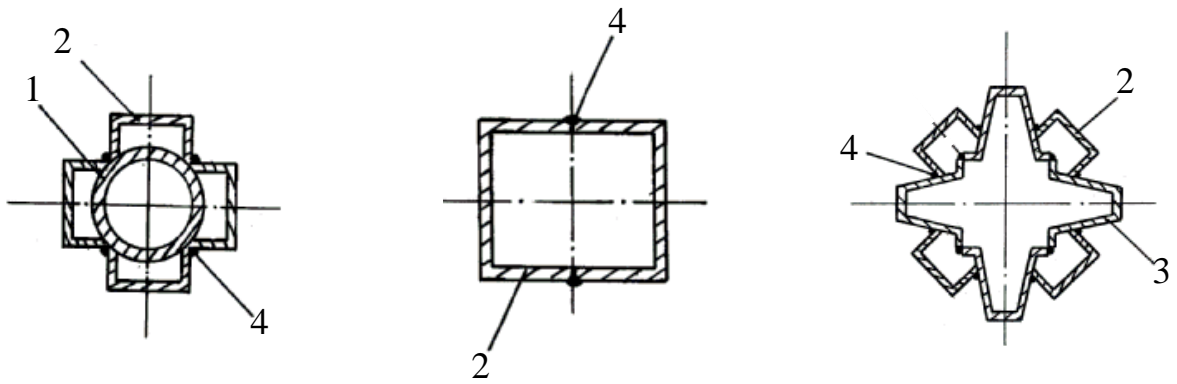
Сварные комбинированные профили камерных стоек: 1 – труба; 2 – швеллер; 3 – СВП; 4 – сварной шов
